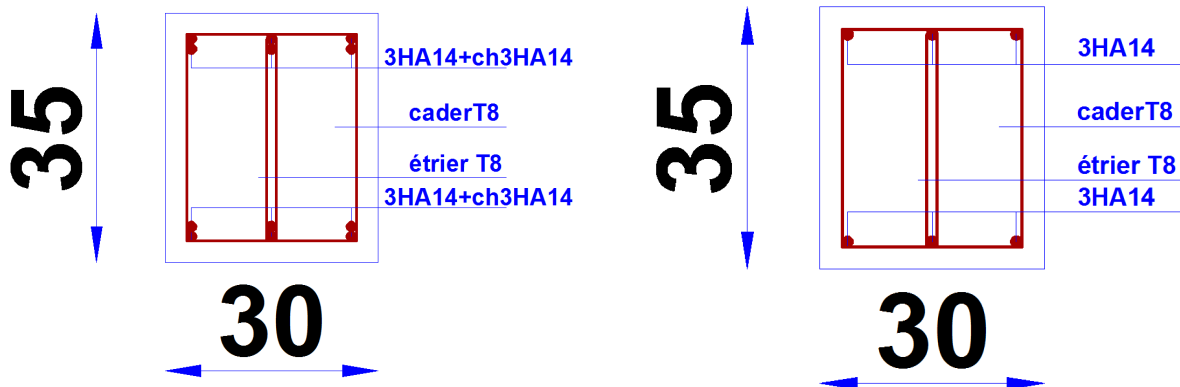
Schéma de ferrailage des poutres secondaires 30X35
